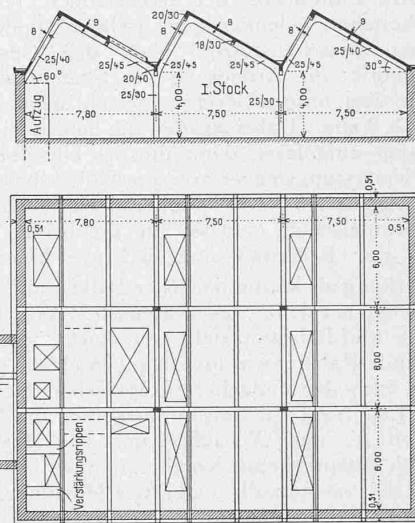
Grundriss und Querschnitt. — Masstab 1:400.
